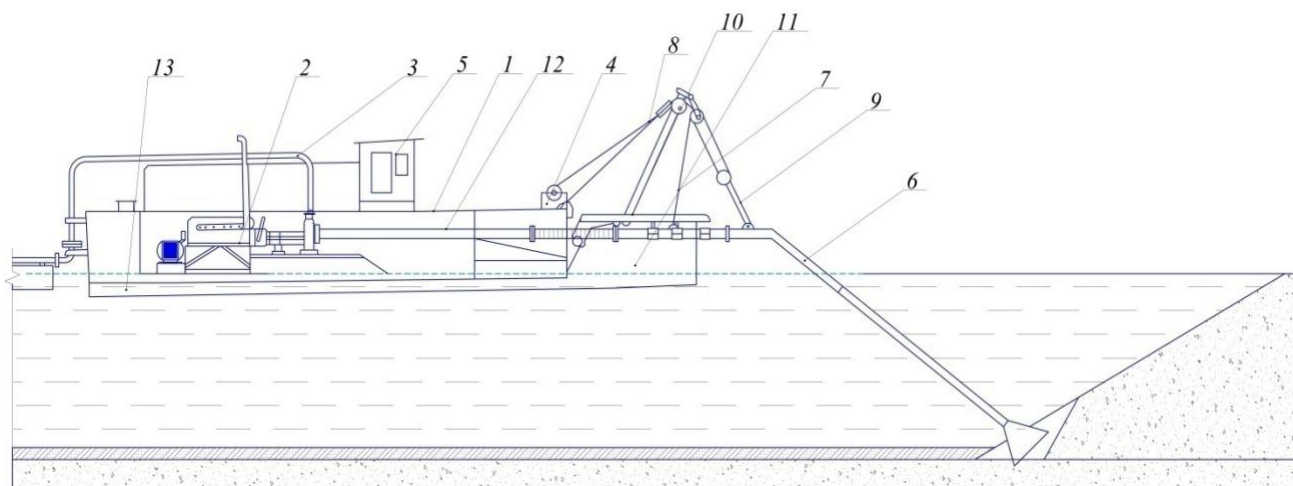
Схема плавучей землесосной установки ПЗУ-8М: 1 — корпус; 2 — двигатель ЗД6СН; 3 — напорный пульпопровод; 4 — лебедка подъема рамы рыхлителя; 5 — рубка управления; 6 — всасывающий патрубок; 7 — укосина; 8 — подвеска укосины; 9 — полиспаст подвески рамы всасывающего патрубка; 10 — подъемная рама рыхлителя; 11 — понтон боковой; 12 — напорный трубопровод; 13 — понтон центральный
